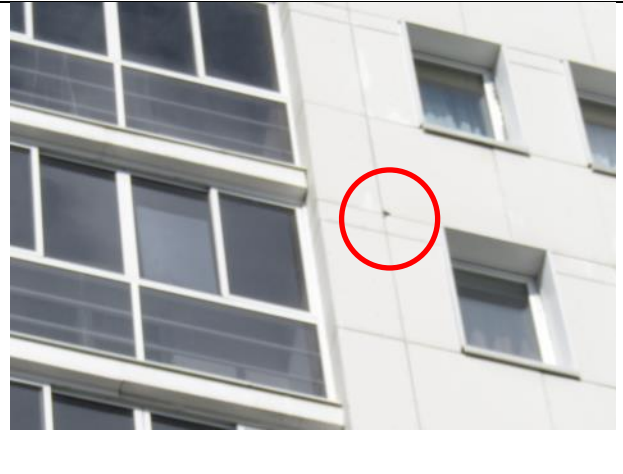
Скол с выпадением части плиты из облицовки главного фасада
